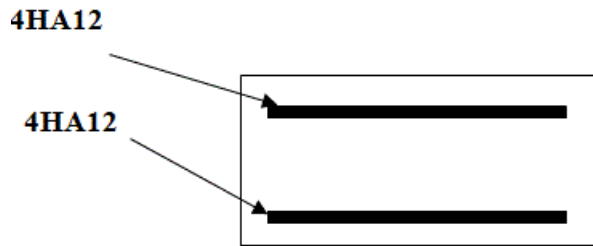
Ferrailage longitudinale de la dalle d'encorbellement
